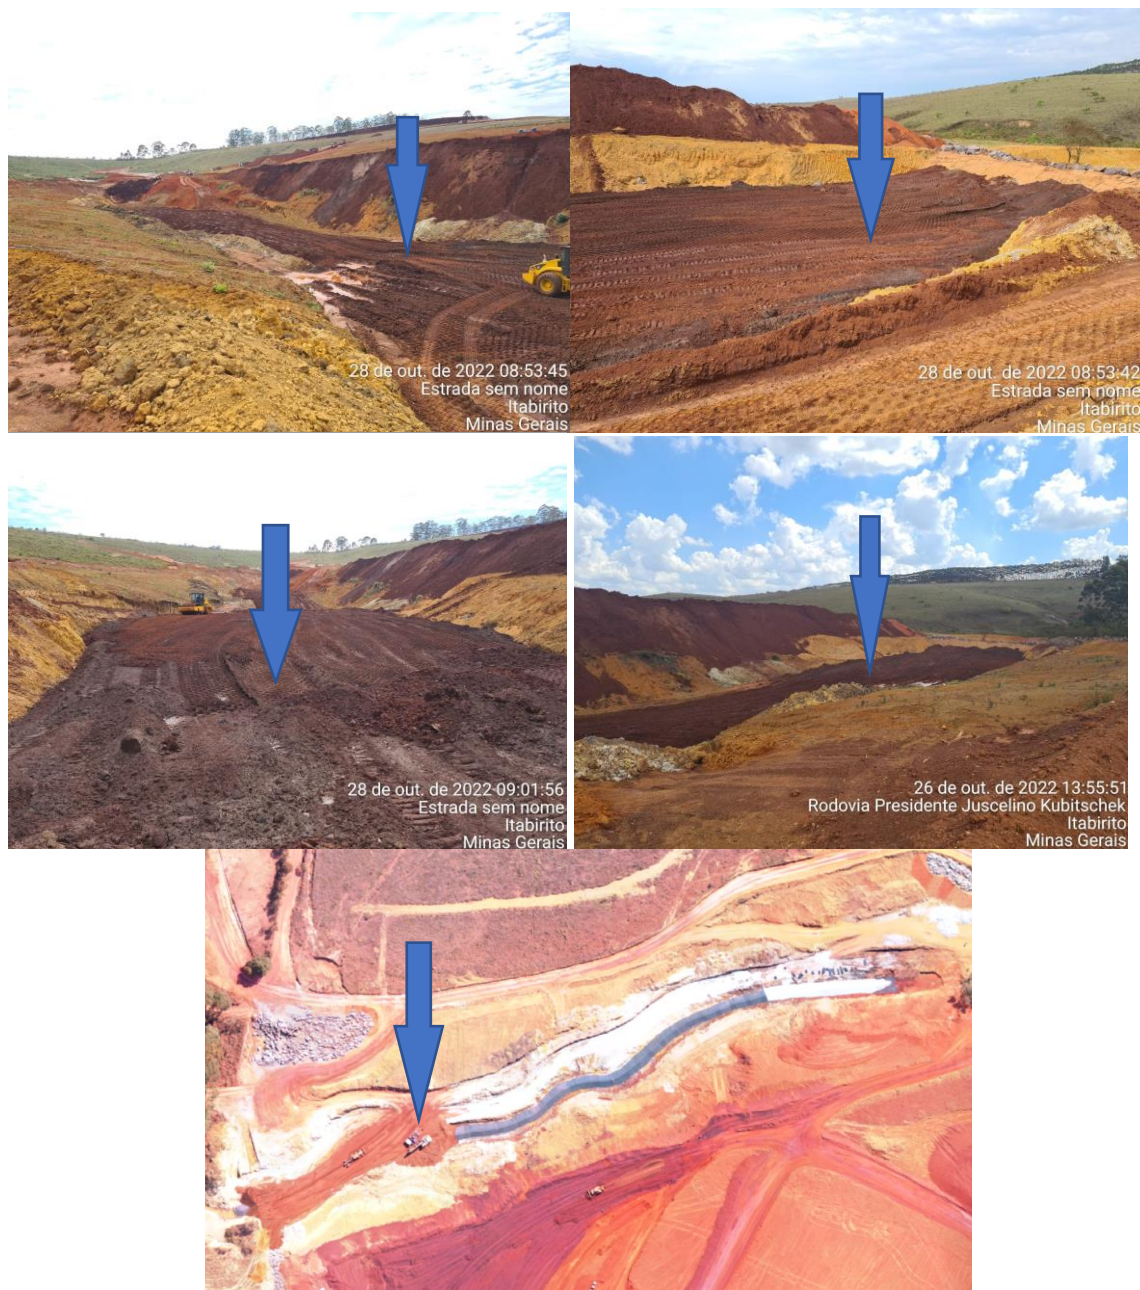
Rejeito grosso (indicado por seta azul) sendo espalhado e compactado por rolo na pilha noroeste.
